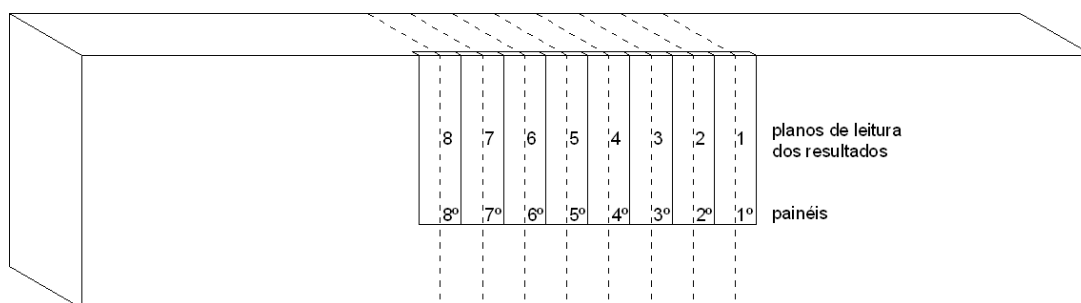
Identificação dos planos de leitura para o modelo 3D com 8 painéis de 5 m.
